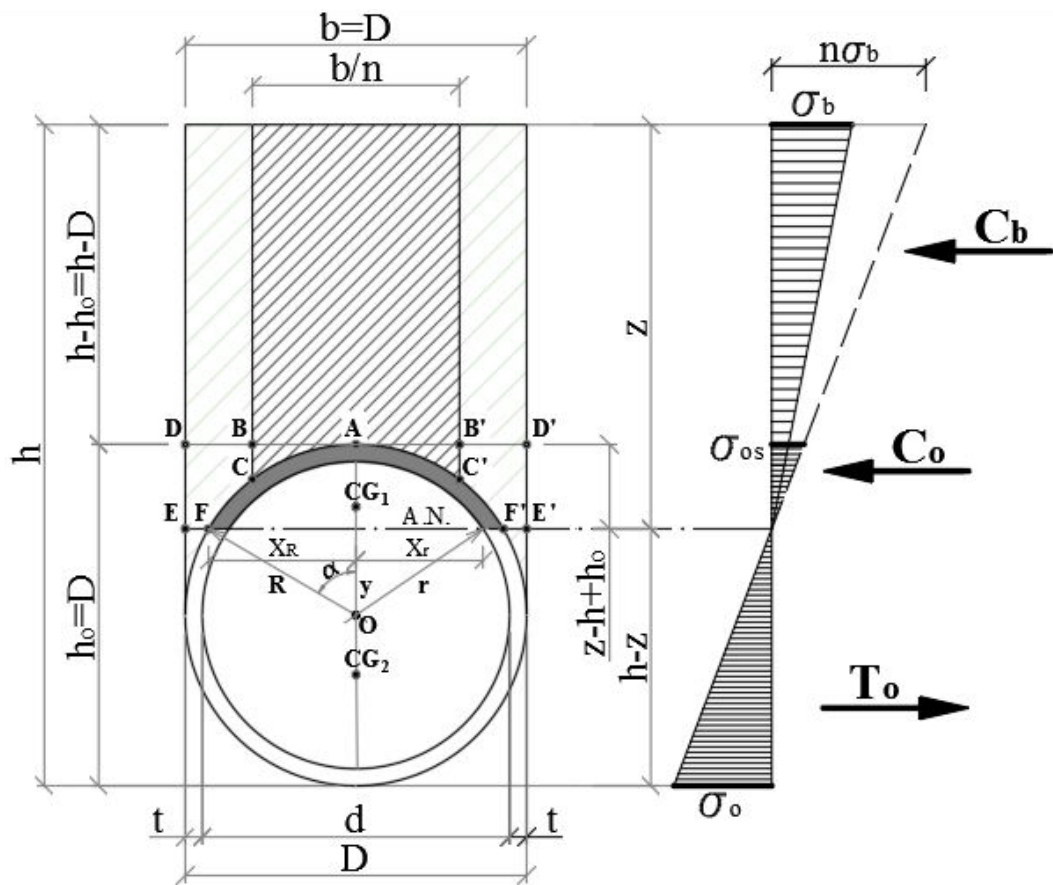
2. Model de calcul pentru structură mixtă oțel-beton cu structura metalică din țevi de oțel tangențiale
